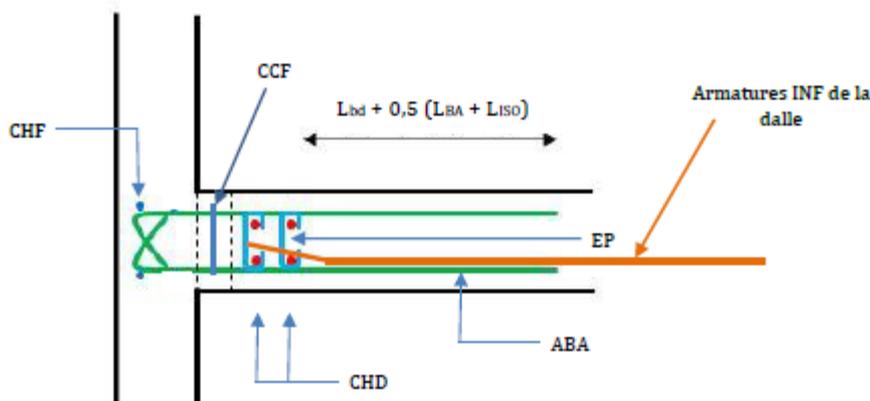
Exemples de dispositions constructives au droit d'une bande d'appui en zone courante
